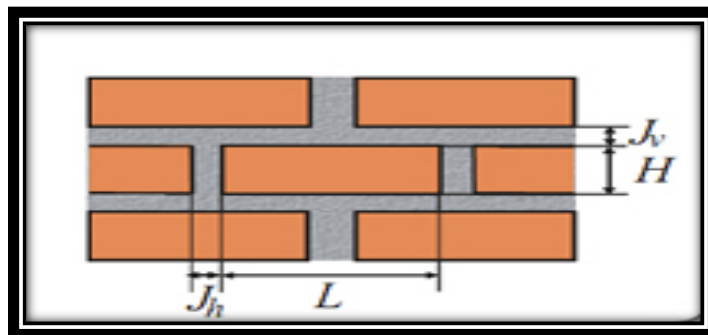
CANTIDAD DE LADRILLOS POR M2 DE MURO.
